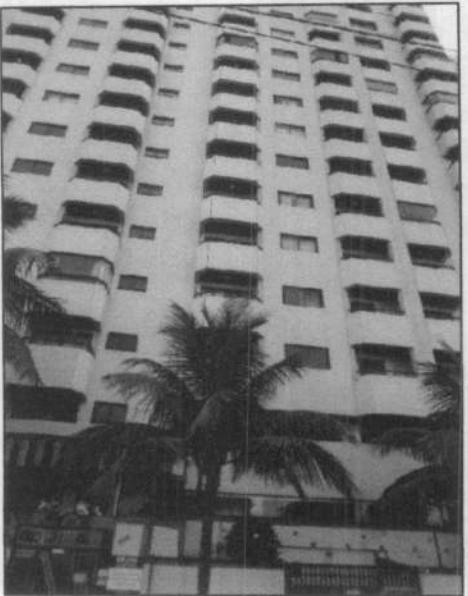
e 02 – Vista da Fachada do Edifício, onde está localizado o apto.
